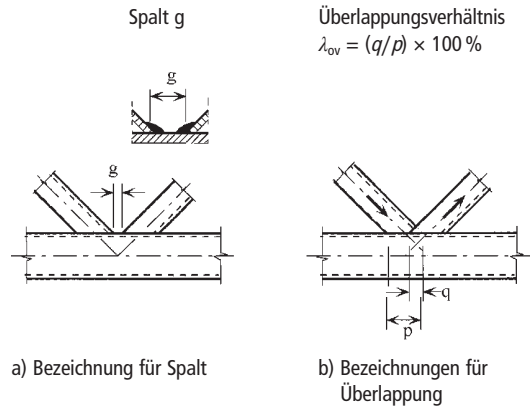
Knotenanschlüsse mit Spalt und mit Überlappung
